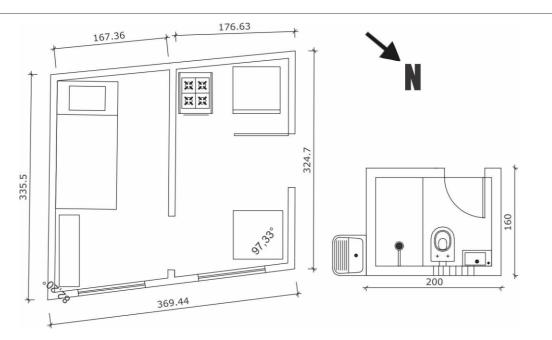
Planta Baixa de levantamento da residência do Seu Ivone
